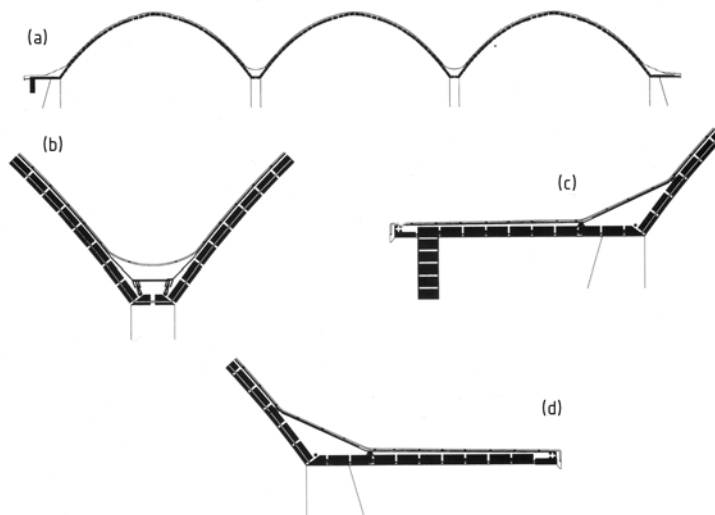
Detalhes dos vales e vigas-lajes dos extremos das abóbadas autoportantes.
